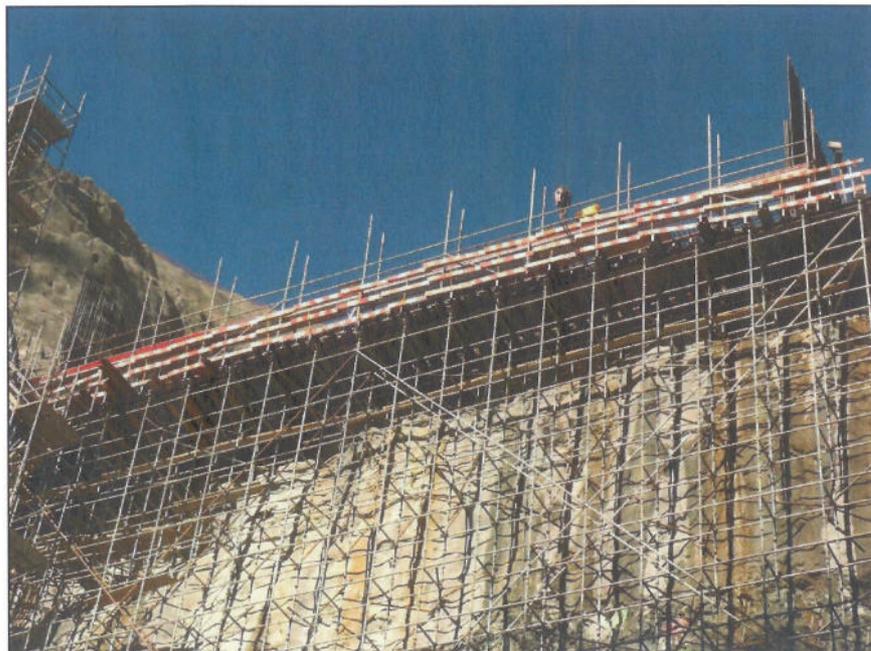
Central – Cimbres de apoio da cofragem do bordo da laje do átrio de descarga
